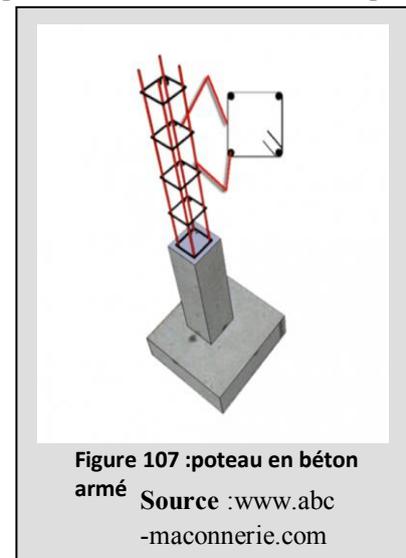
poteau en béton armé Source :www.abc-maconnerie.com
